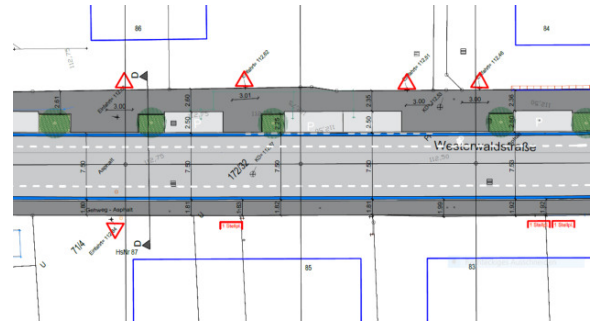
Ausschnitt Planung Westerwaldstraße 2 BA;
